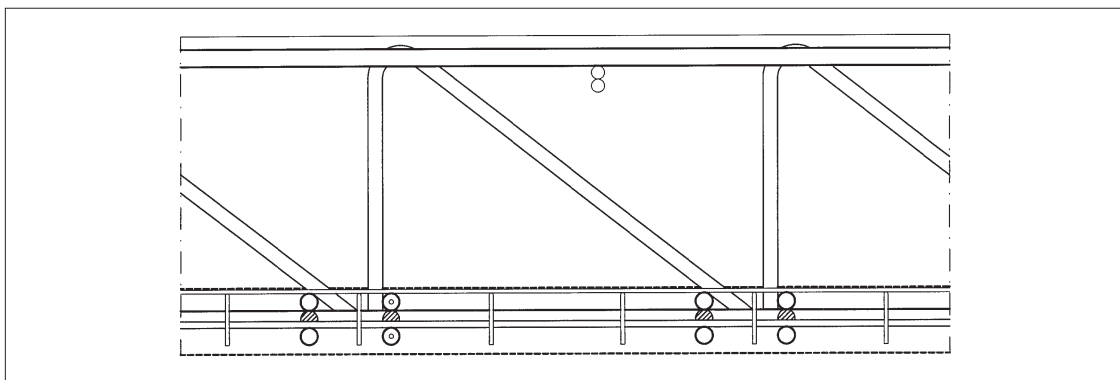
Struttura trasversale in acciaio (vista laterale).
